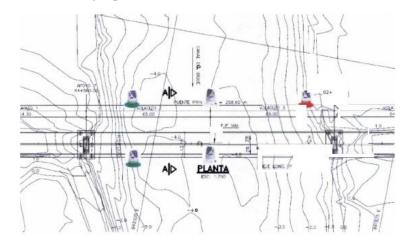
Ejemplo de Vista de Planta Señalización Nocturna Puentes
